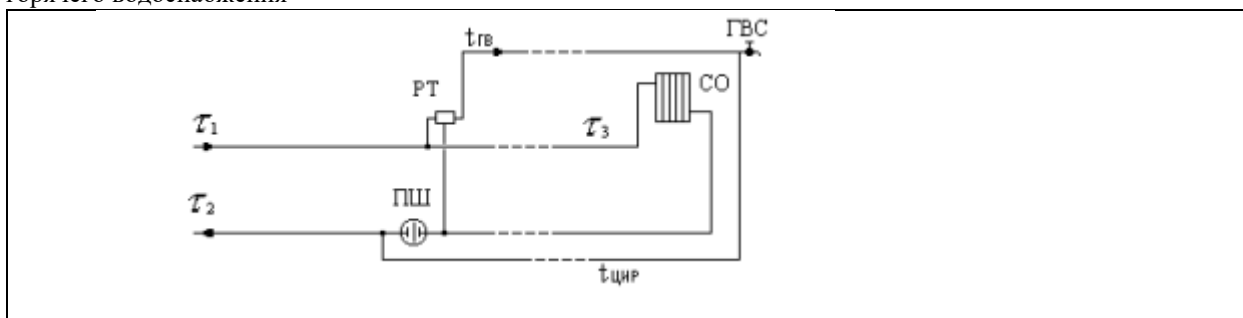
Схема ИТП с насосом смещения на подающем трубопроводе
